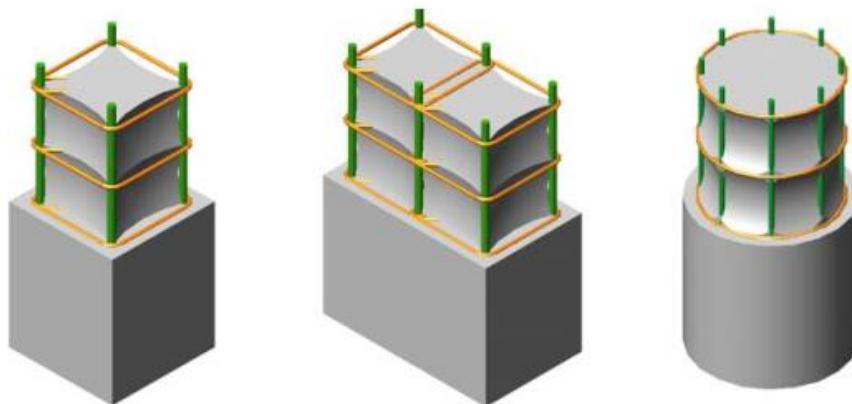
Arqueamento das tensões de confinamento nos pilares de concreto armado. (Oliveira, 2008)
